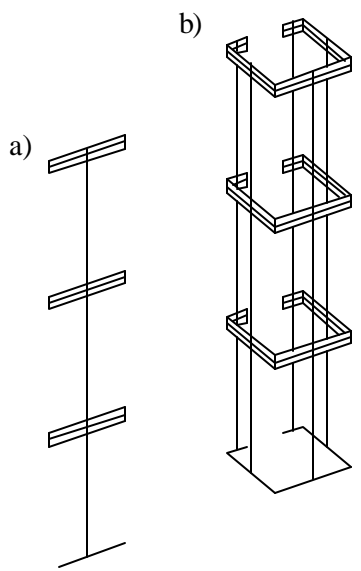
a) Segmento de parede b) Núcleo Estrutural
